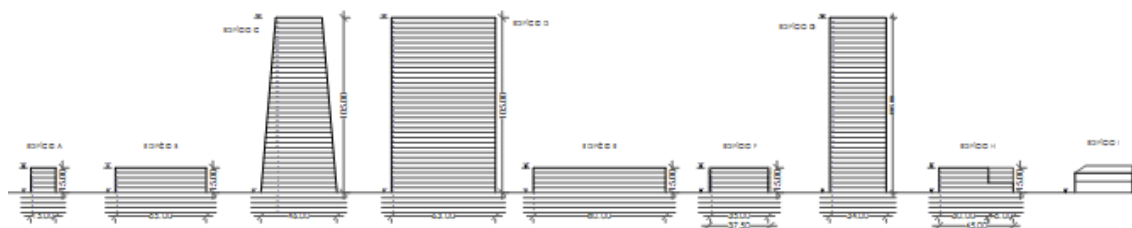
Corte esquemático do projecto Nova Alcântara do Arquitecto Álvaro Siza (fonte: imagem disponibilizada pelo ateliê Castanheira e Bassai, Arquitectos Associados).
